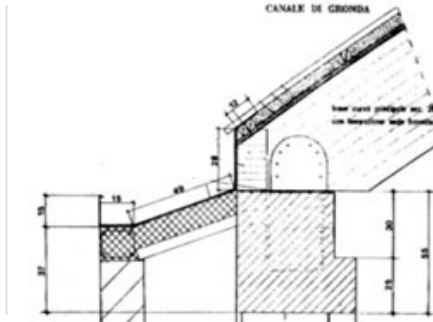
Canale di gronda e connessione delle travi lamellare con i pilastri di bordo.
